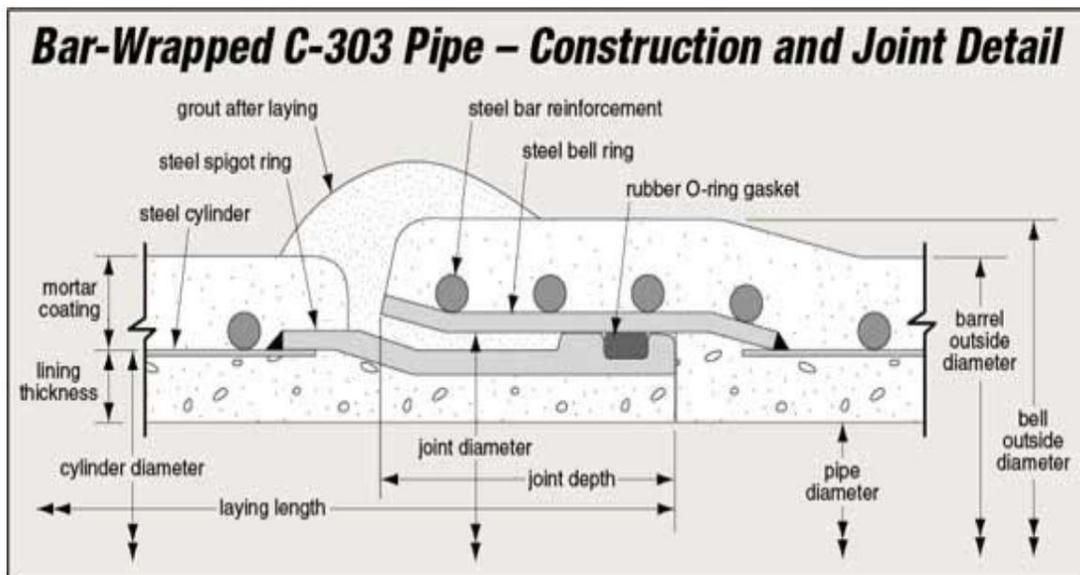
Detalle de Unión o Junta constructiva para CCP (Fuente: AWWA Manual M9)
